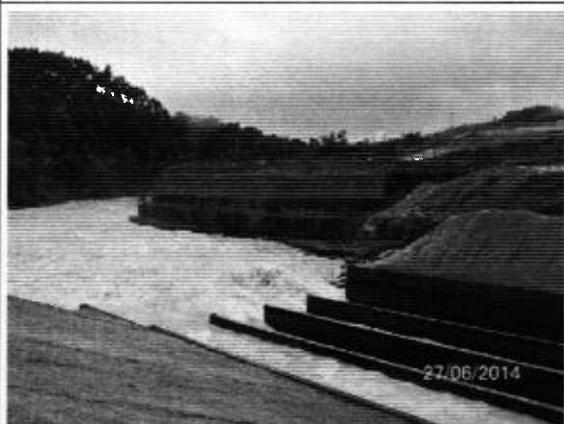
\_8018: Muro de concreto em construção, junto à saída dos descarregadores de fundo.
